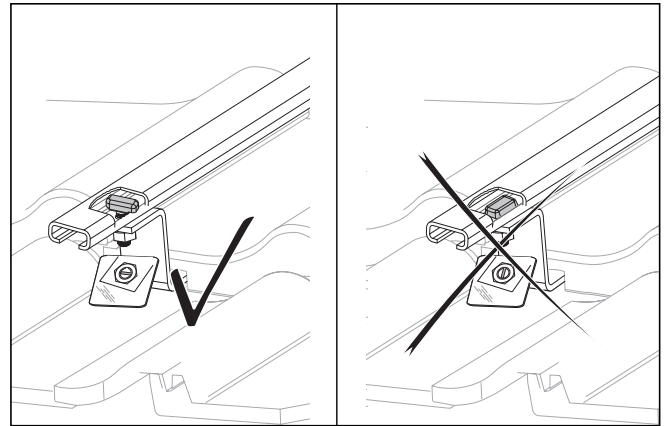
Hammerkopfschraube richtig verschrauben
